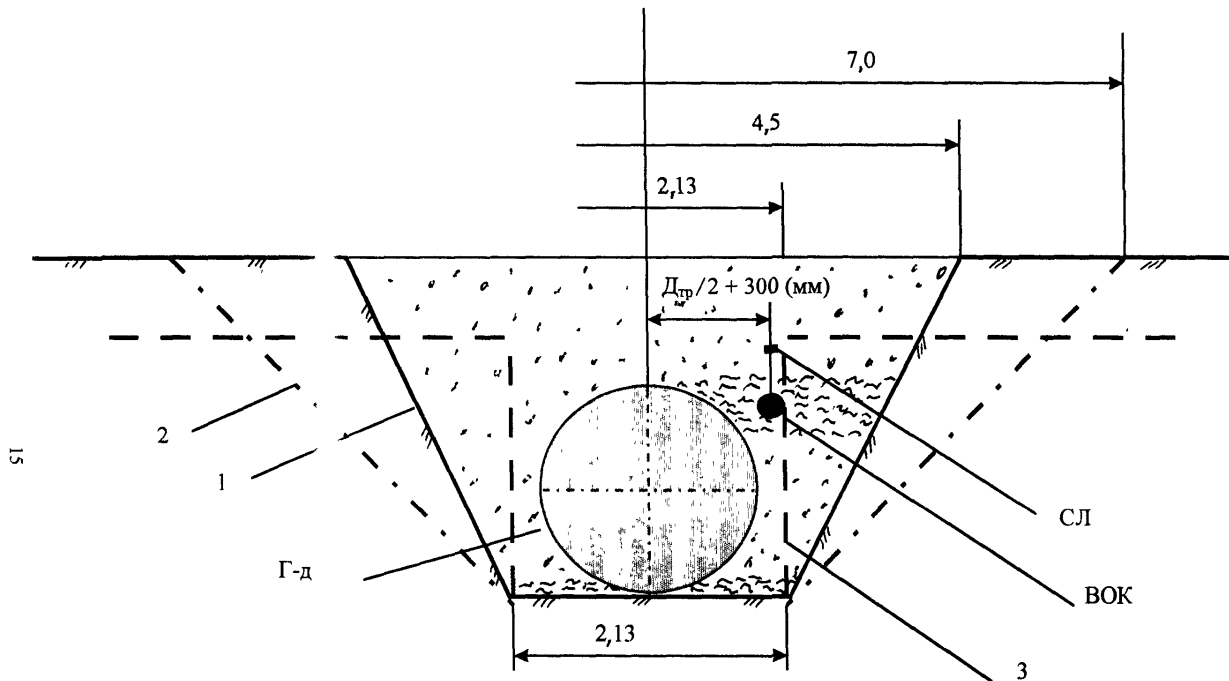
Схема размещения защитной трубки с ВОК связи в траншее газопровода 1420 мм
